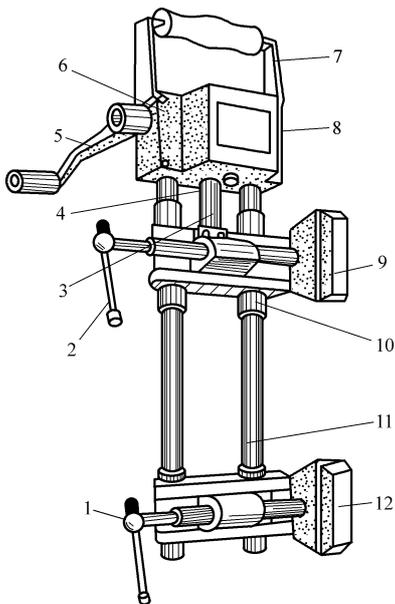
竖向钢筋电渣压力焊机主机构造简图
